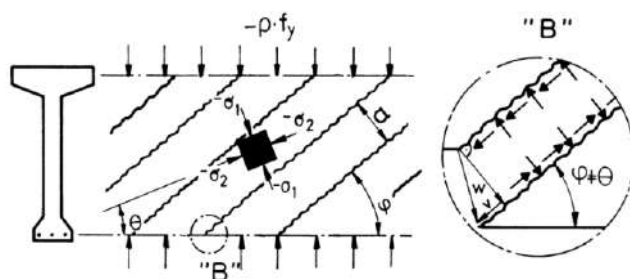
Estado de tensões na alma para Modelo de Fissura Fixa [162].
